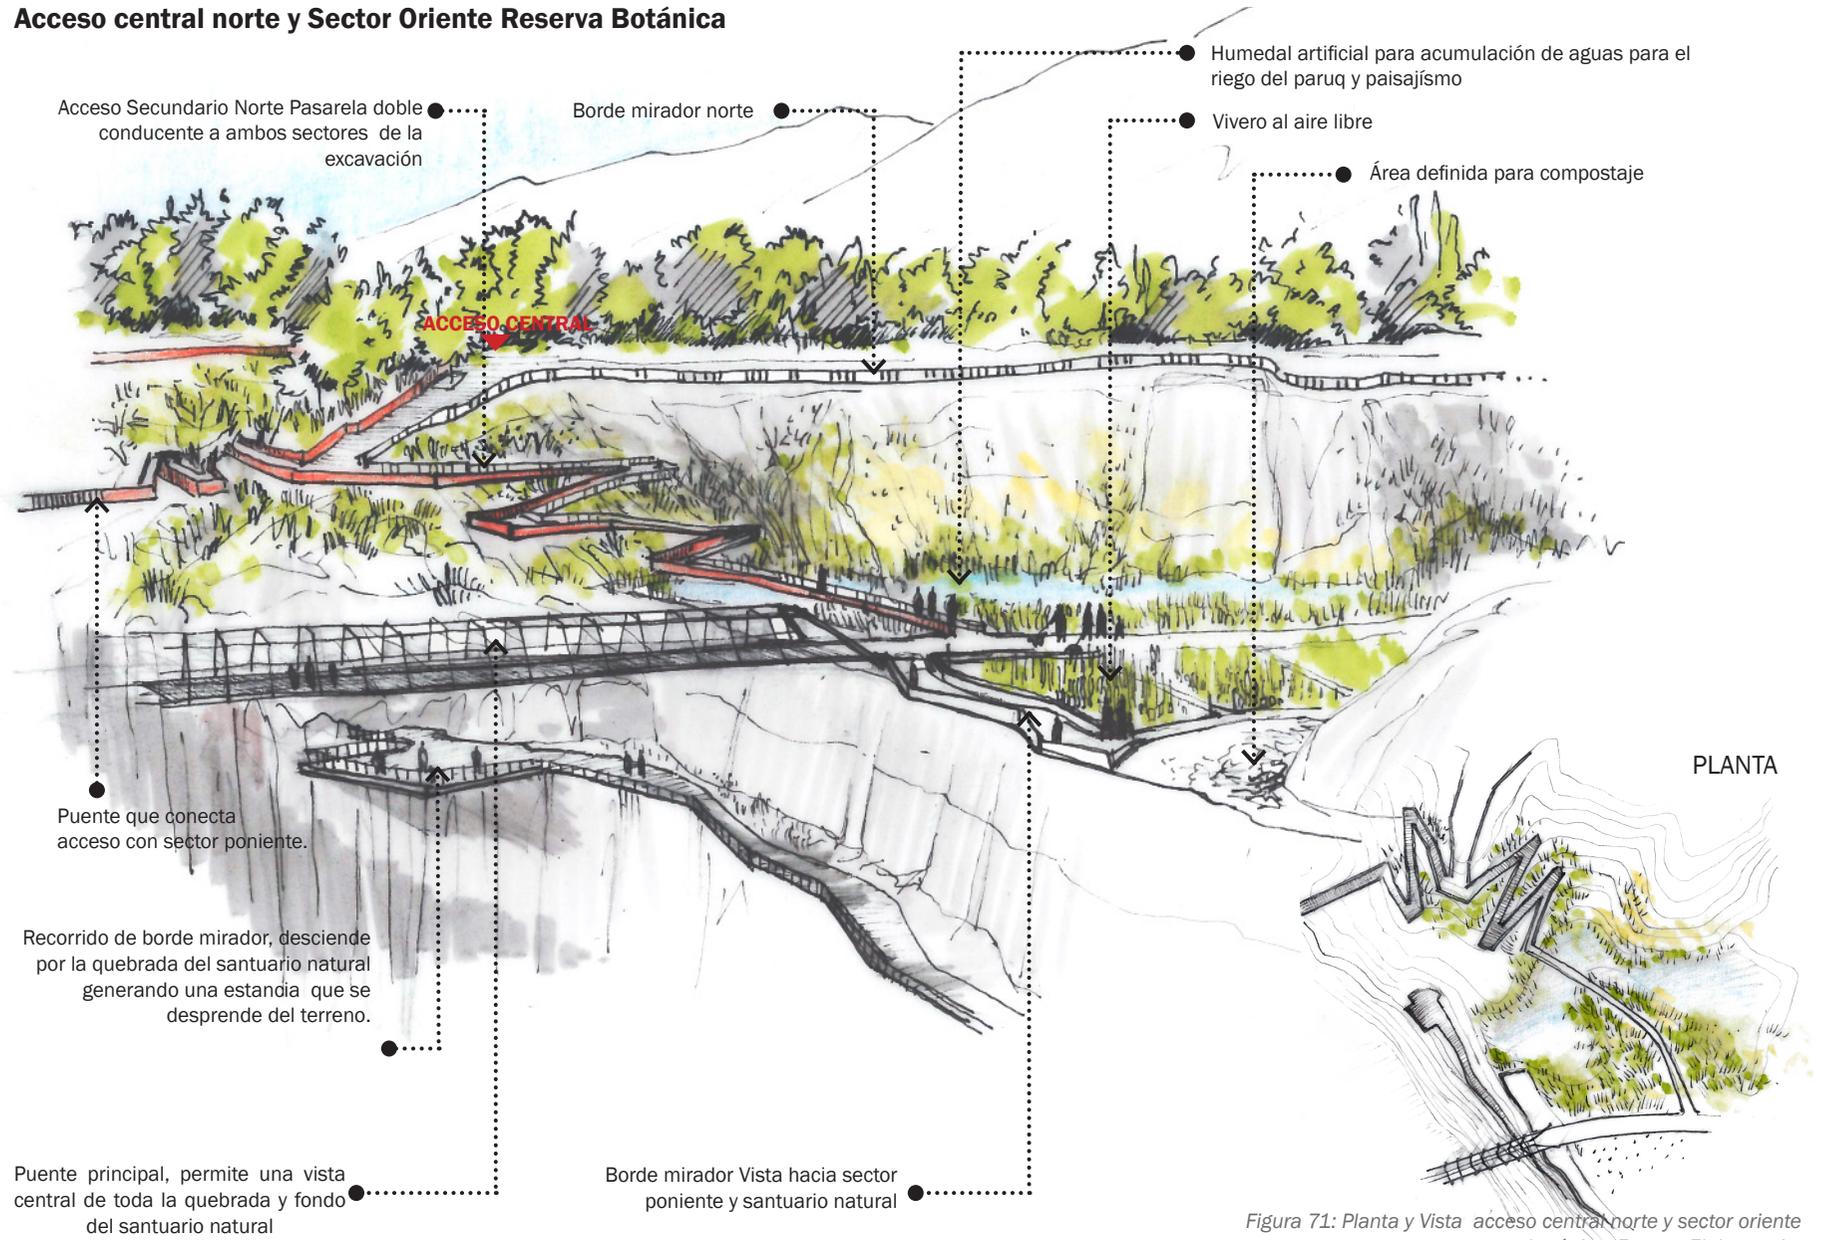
Planta y Vista acceso central norte y sector oriente reserva botánica. Fuente: Elab. propia.
